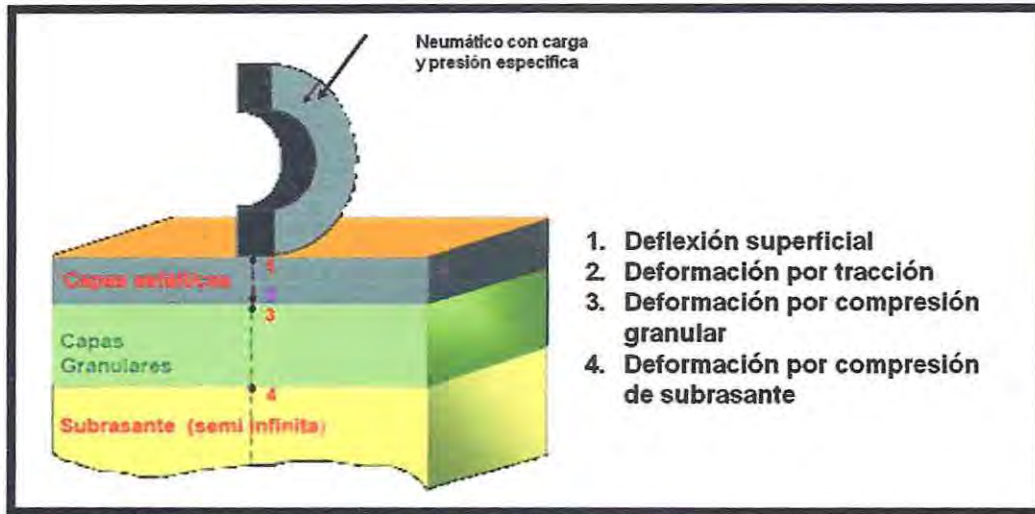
Puntos de tensiones y deformaciones en la estructura del pavimento [22]
